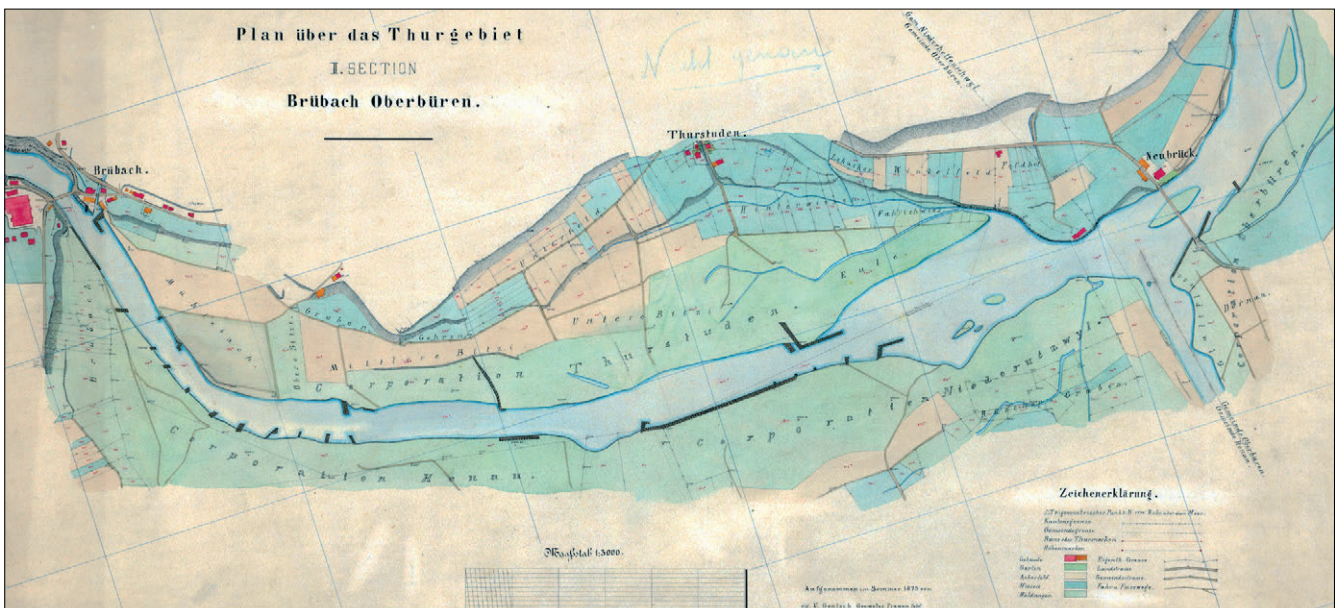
Ausschnitt aus dem Plan der Thur, Abschnitt Brübach-Oberbüren 1875 (Staatsarchiv St.Gallen, KPM-2-12.09)
